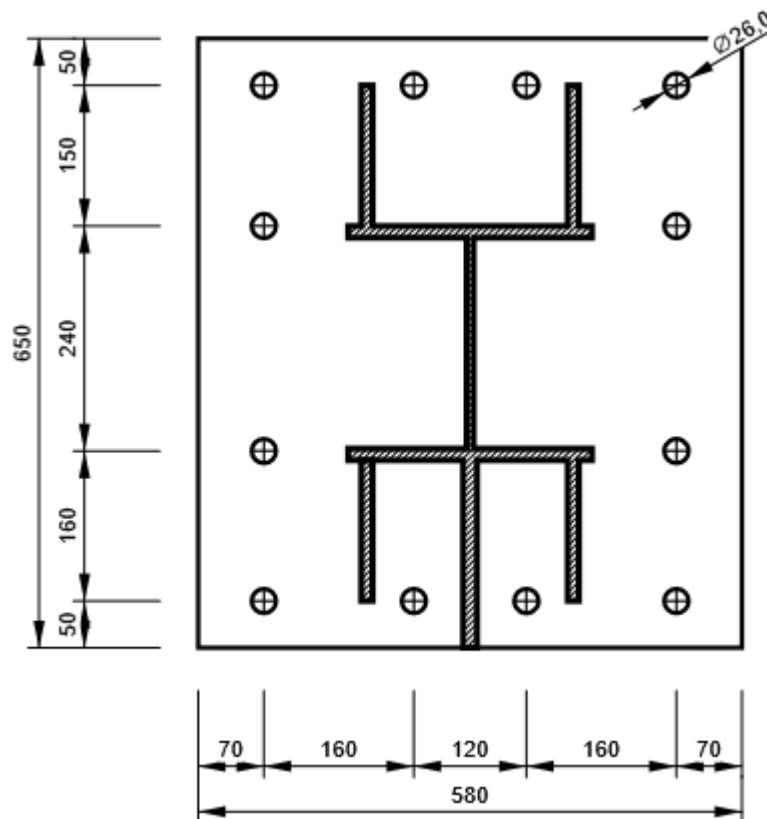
Dimensions et disposition des boulons et cordons de soudures sur la platine.
